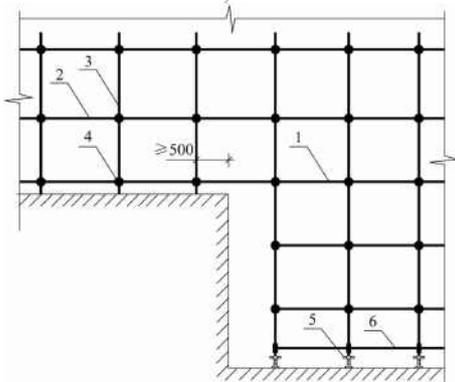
基础顶面高差较大时扫地杆构造
